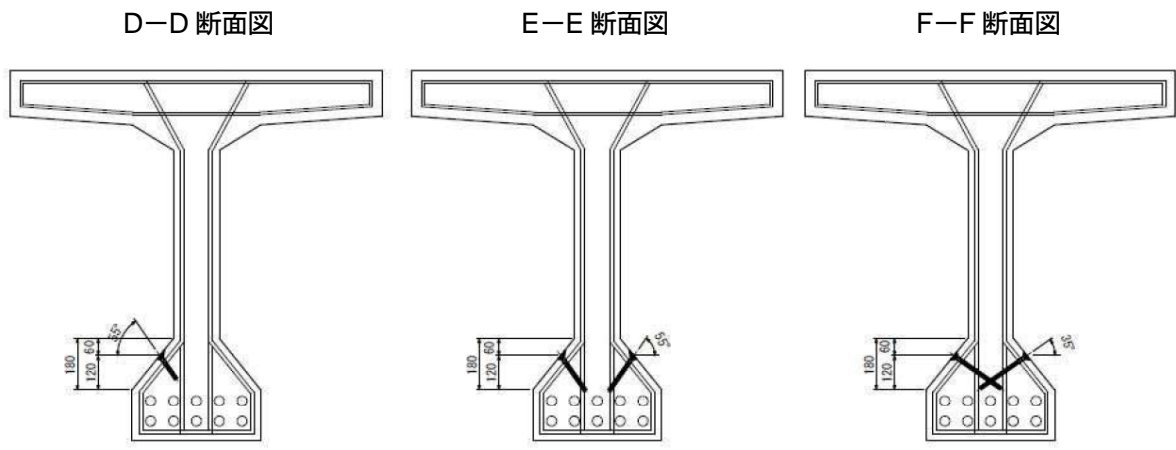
陽極の配置図（図-1.1.1 の断面図の拡大図）
